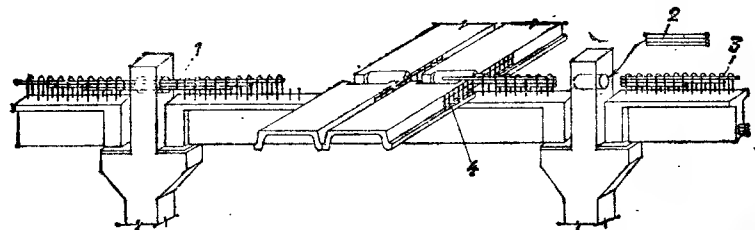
Сборно-монолитная конструкция каркаса многоэтажного здания 1 — арматура, закладываемая в колонну при замоноличивании; 2 — арматурные коротышки; 3 — арматурные выпуски из ригелей, предназначенных для замоноличивания; 4 — арматурные сетки, закладываемые в швы между плитами при замоноличивании
